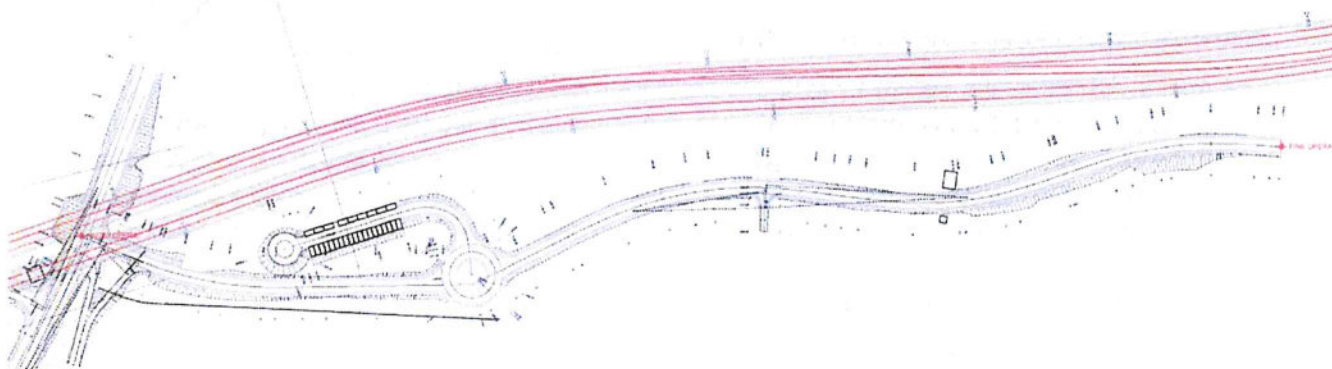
NV05 – Stralcio planimetrico su rilievo di Via L.Fava
